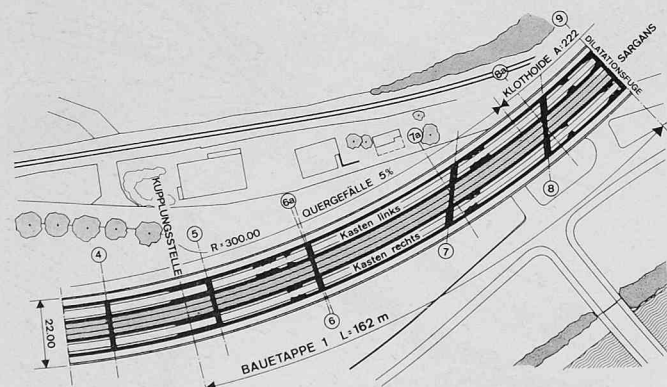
Grundriss erste Bauetappe 1:2500
